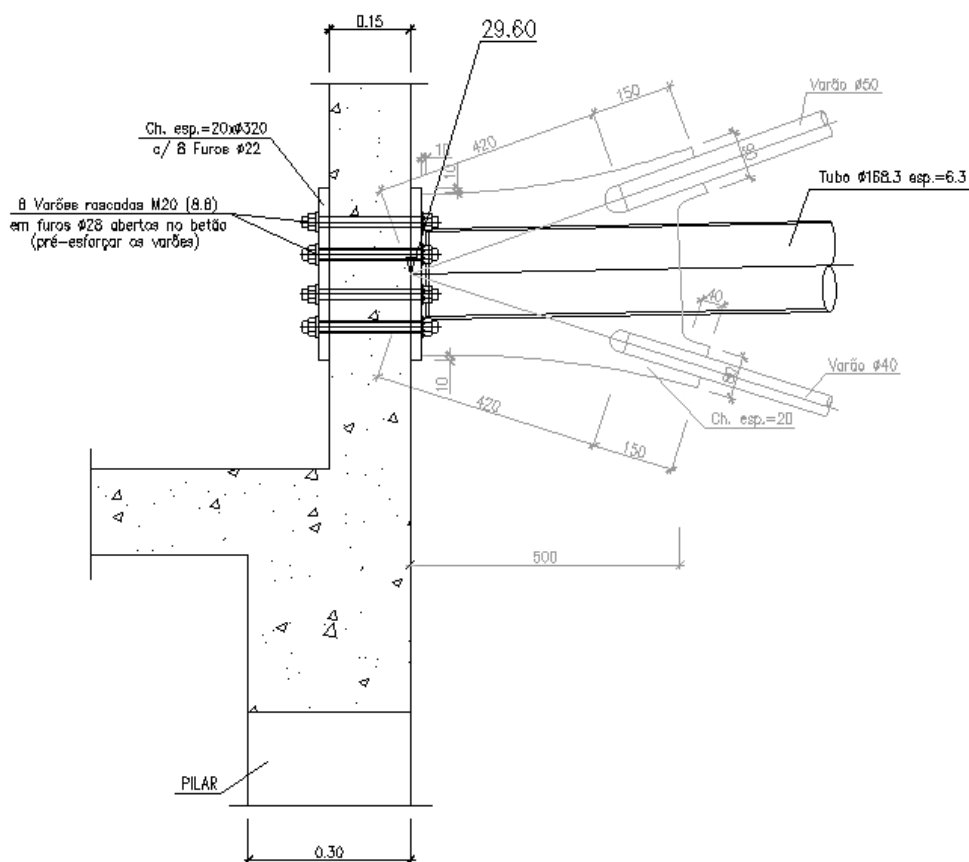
Pormenor construtivo de uma ligação utilizando parafusos roscados atravessando uma viga-parede de betão armado, (Cima Gomes; Biscaia, N., 2008)
